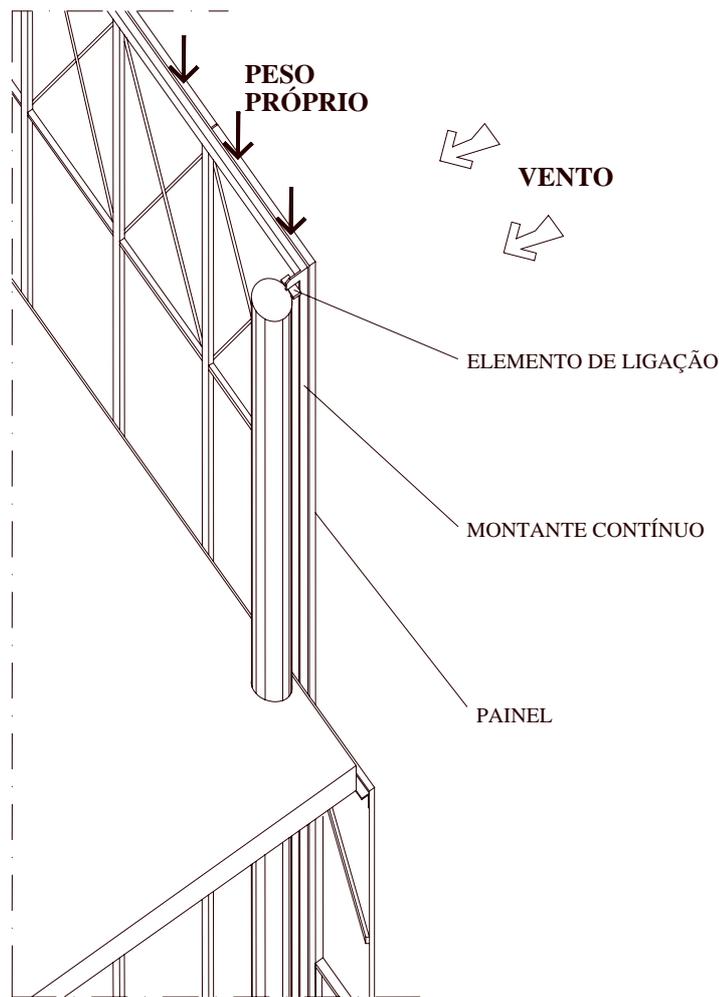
Perspectiva de um painel cortina metálico fixado nos pilares.
